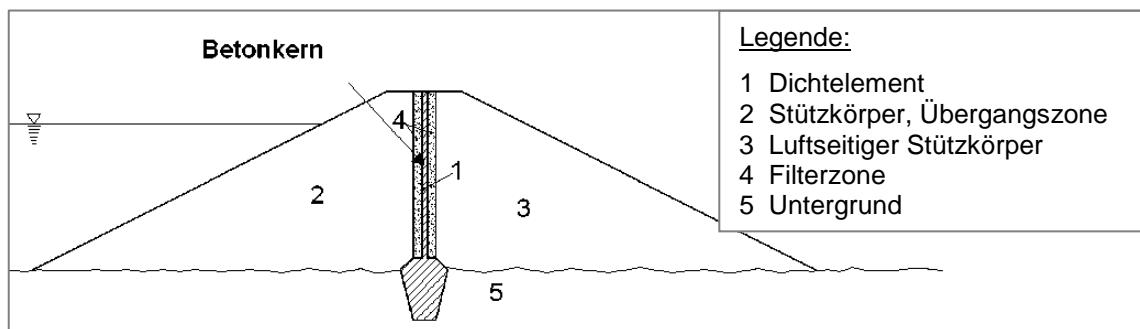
Damm mit Innendichtung [59: S. 22]
